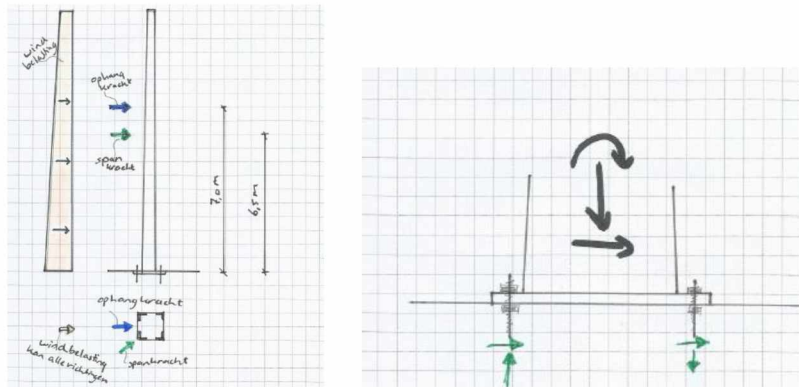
bovenaanzicht en zijaanzicht betongedeelte en ankers diam 14 mm
